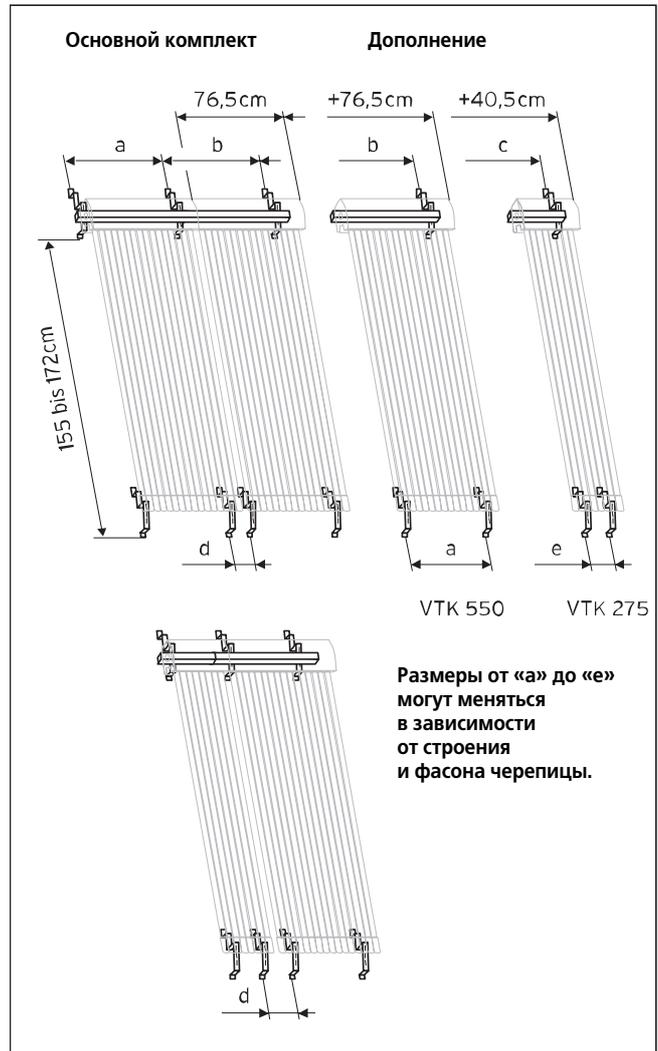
Размеры и промежутки, а так же положение анкеров для монтажа на крыше и настенных крюков для монтажа на фасаде трубчатых коллекторов Vaillant auroTHERM exclusiv
